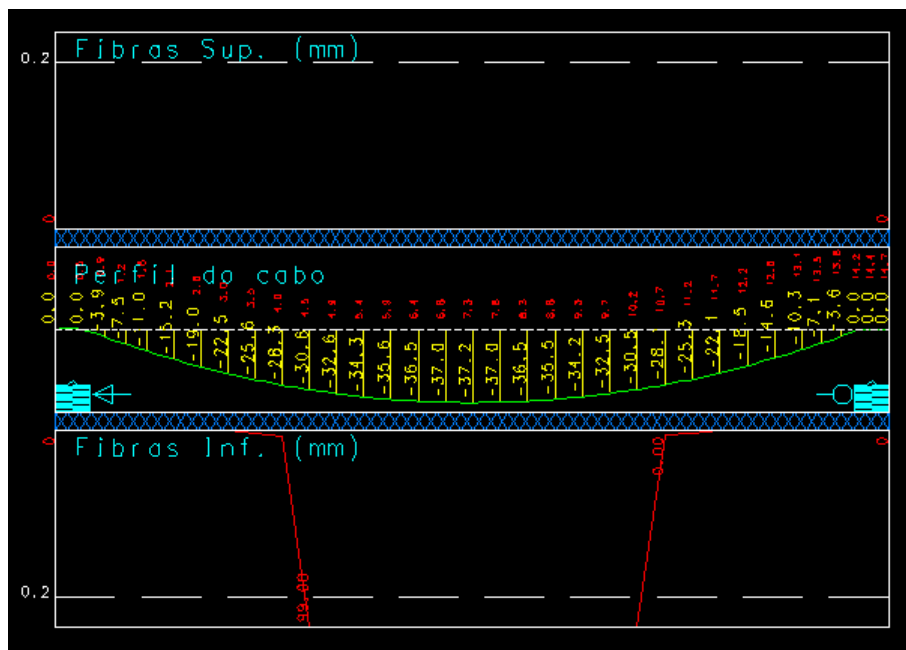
Fissuração viga V10 do 2º pavimento (CAD/TQS)
